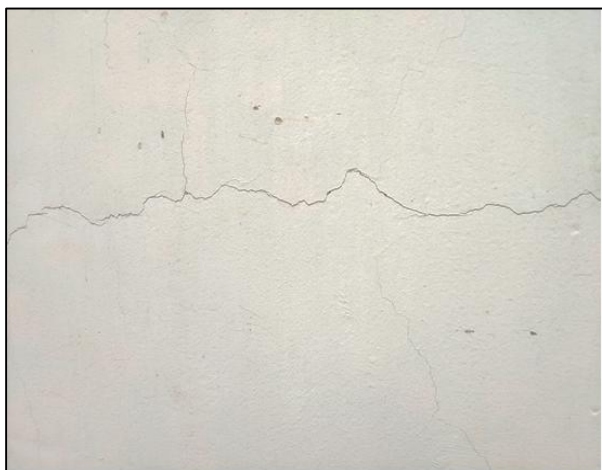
Presencia de humedad en la estructura de concreto armado. Fuente: Elaboración propia.
